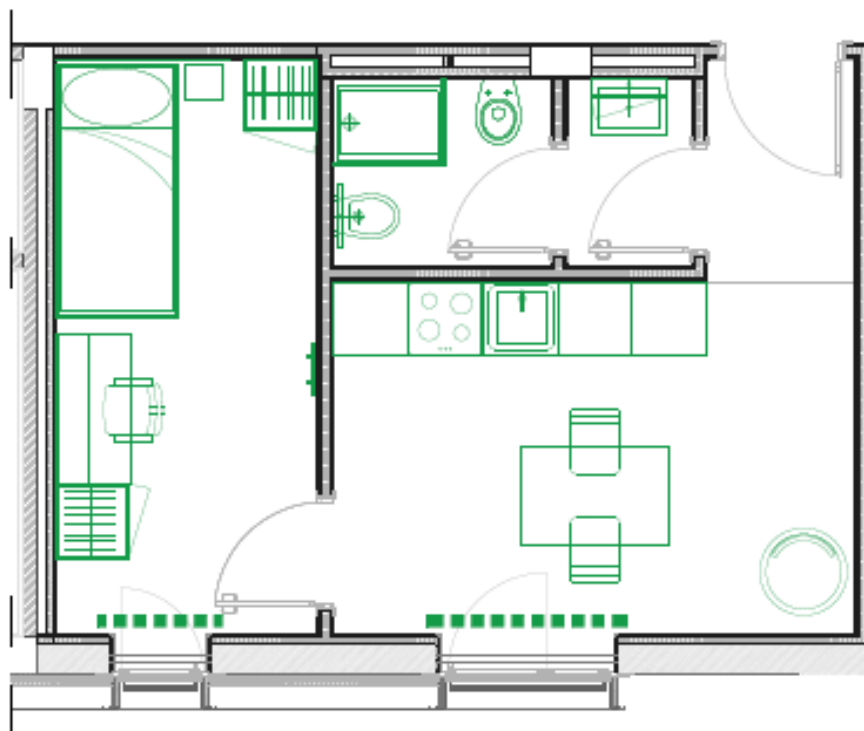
Pianta tipologia Vega - Fonte: archivio In-Do
